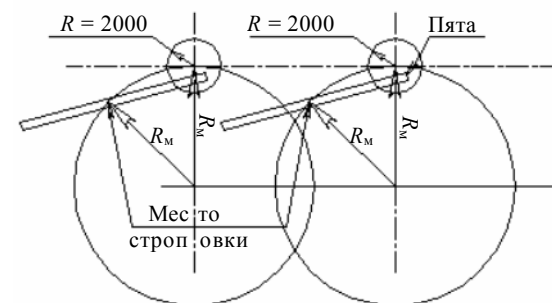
Схема монтажа колонн методом поворота вокруг пяты
